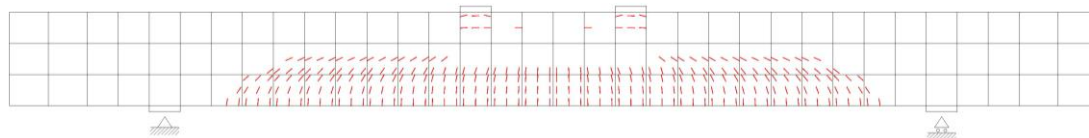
破壊時の変形及びひび割れ状態 (Case No. 8)
